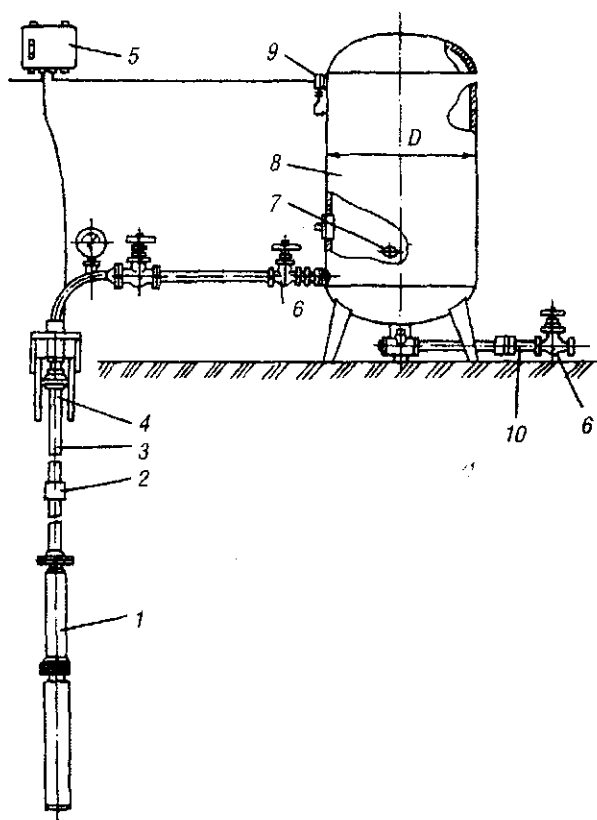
Схема автоматической водоподъемной установки с погружным насосом: 1 – погружной насос; 2 – муфта с калиброванным отверстием; 3 – напорный трубопровод; 4 – обратный и воздушный клапаны; 5 – шкаф управления; 6 – задвижка; 7 – регулятор запаса воздуха; 8 – гидроневматический бак; 9 – реле давления; 10 – водоразборный трубопровод
